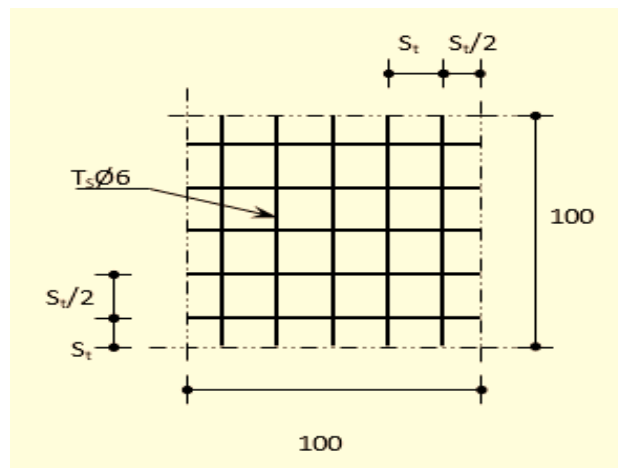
Disposition constructive des armatures de la dalle de compression
